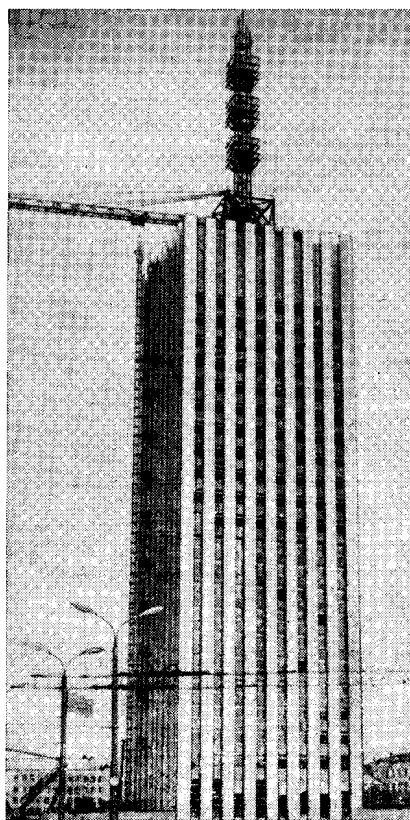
22-этажное здание с наружными стеновыми панелями из шунгизитогазобетона
